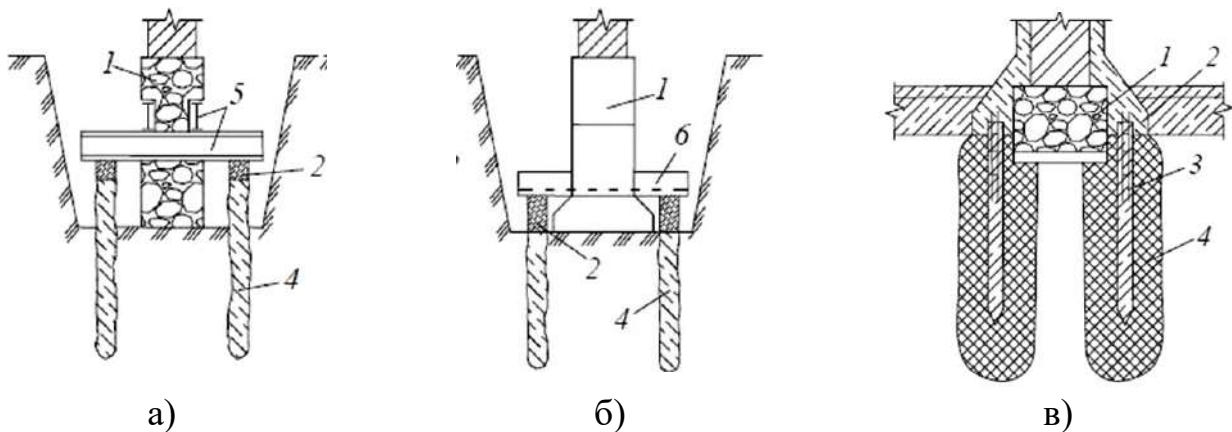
Варианты усиления ленточных (а, б) и столбчатых (в) фундаментов набивными сваями: 1 – фундамент; 2 – ростверк; 3 – набивные сваи; 4 – зона уплотненного грунта; 5 – металлические балки; 6 – балка, бетонируемая на месте
